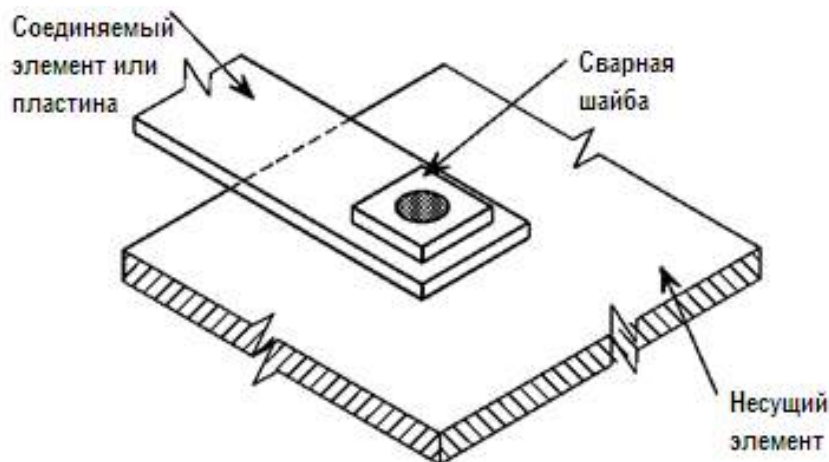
Дуговая точечная сварка со сварной шайбой
